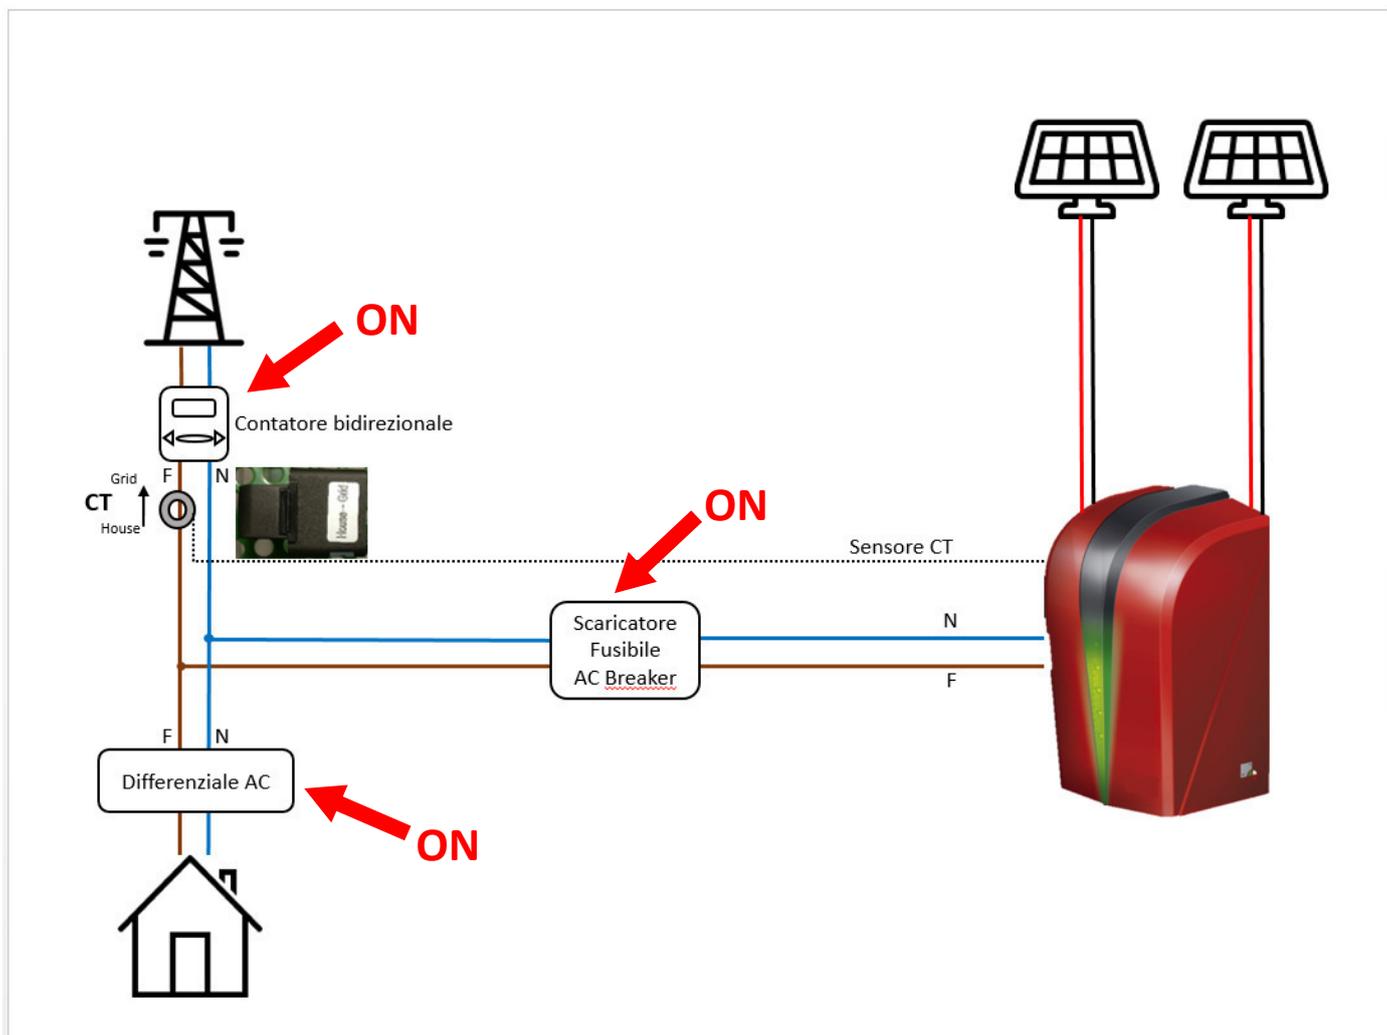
Attivazione (ON) dei dispositivi di protezione e sezionamento sull'impianto elettrico
